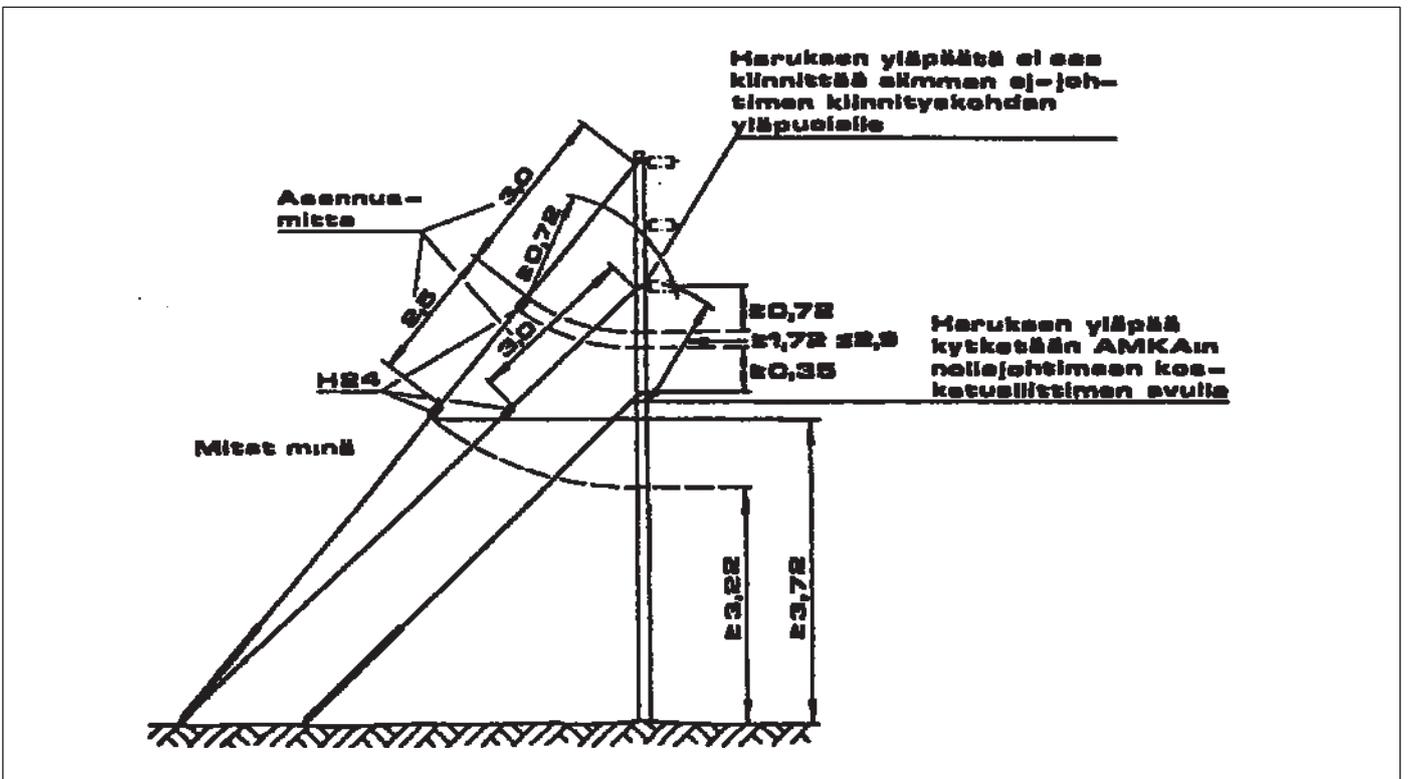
Установка оттяжек на угловую общую опору напряжением 20 кВ с натяжным изолятором.
